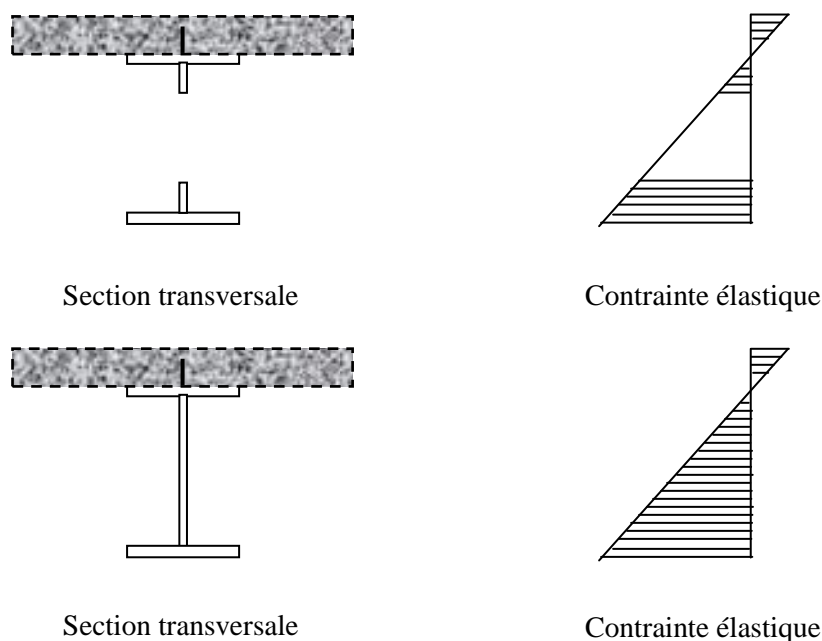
Caractéristiques élastiques d'une poutre mixte ajourée
